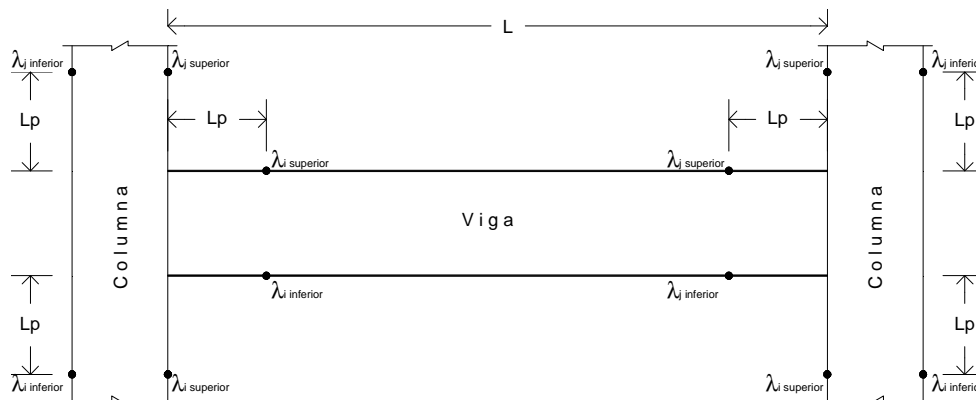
Ubicación de los índices de daño locales en los elementos estructurales
